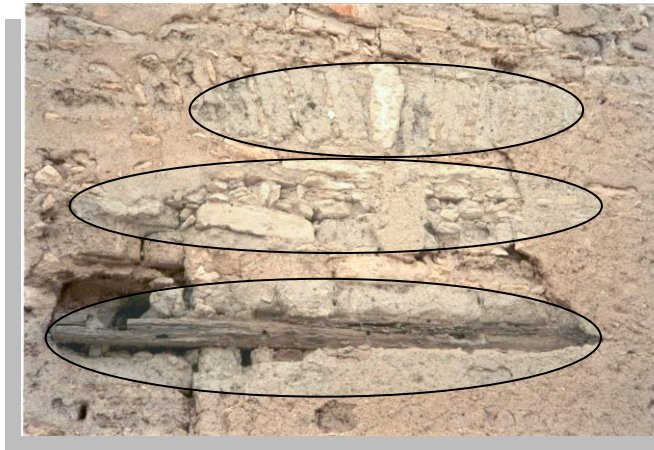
Vista de los sistemas de construcción sobre el dintel de una puerta en donde se puede apreciar la utilización de diferentes materiales constituidos por piedra, adobe, madera y tepetate.
